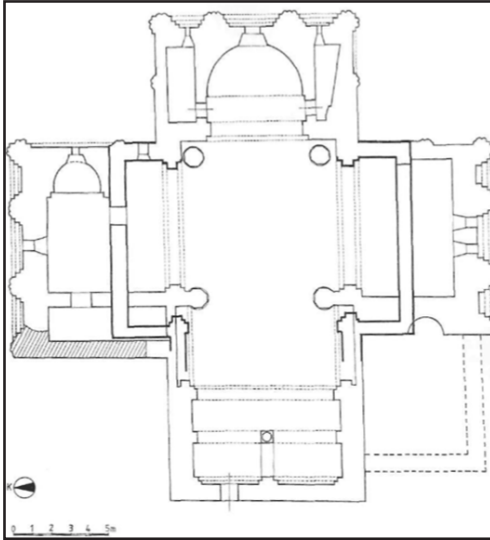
Tbet (Tbeti) Manastır Kilisesi ve Genel Planı (Pavlinov'dan, 1888 ve 1893).
